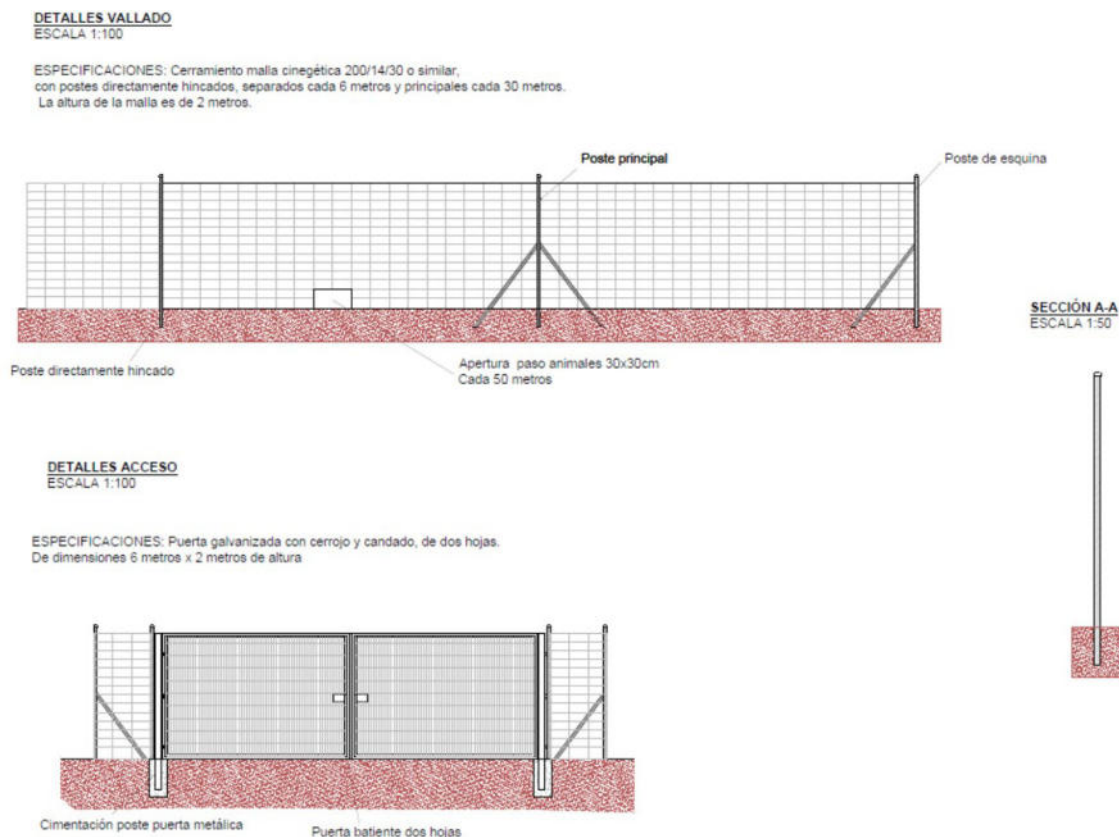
Detalle del cerramiento perimetral de la instalación fotovoltaica. Fuente: Proyecto de ejecución de la planta solar.
